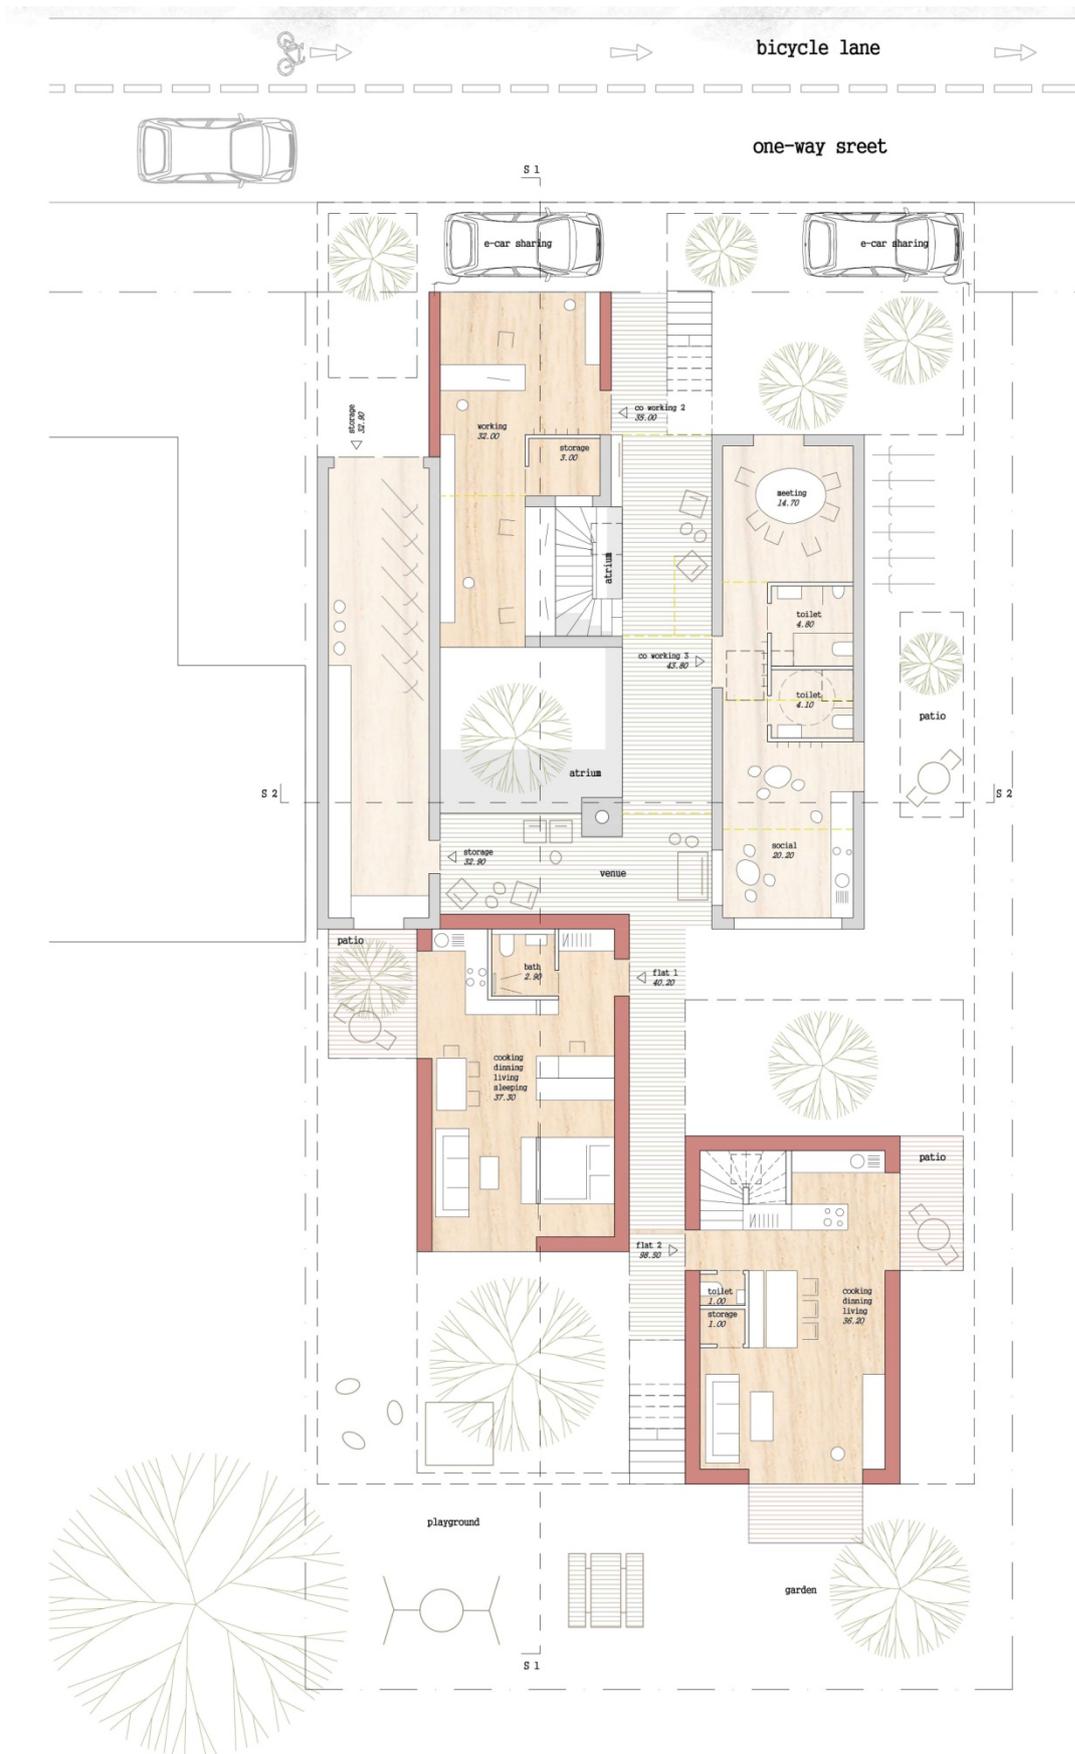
Grundriss Erdgeschoss (eigene Darstellung)
